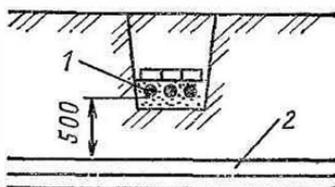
Пересечение кабелей с трубо-, водо- и газопроводами:
